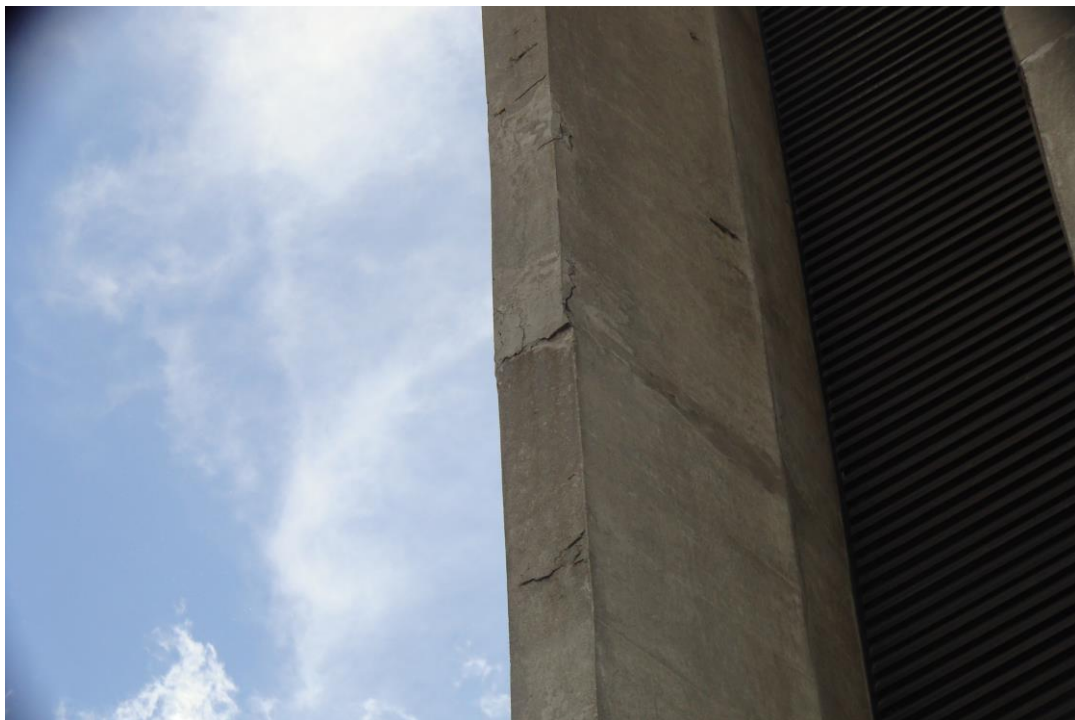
Armadura exposta pilar P11 (9º pavimento) (19/11/2013)
